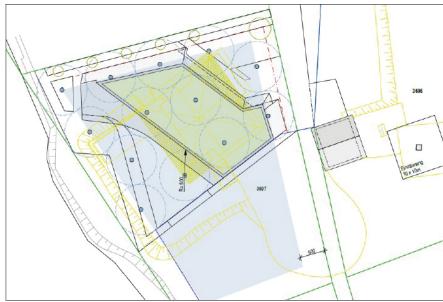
Lageplan mit eingetragenen Tiefensonden (Quelle: Mario Gasser Architecture);
